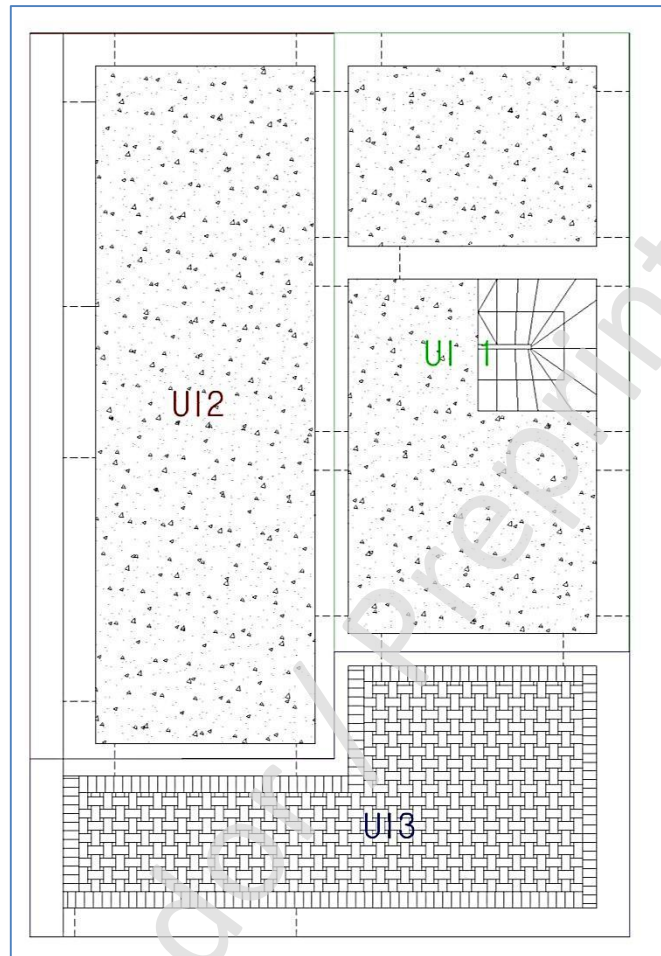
Planta de la intervención a cota de fin de excavación
